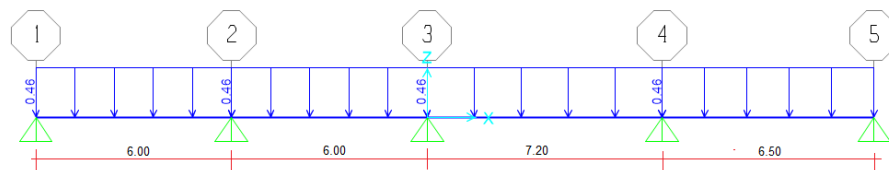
Modelo estructural de vigueta tipo I (ton/m)
